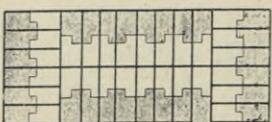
Halboffene Bauweise in England, Holland, Bremen. 1:4000
